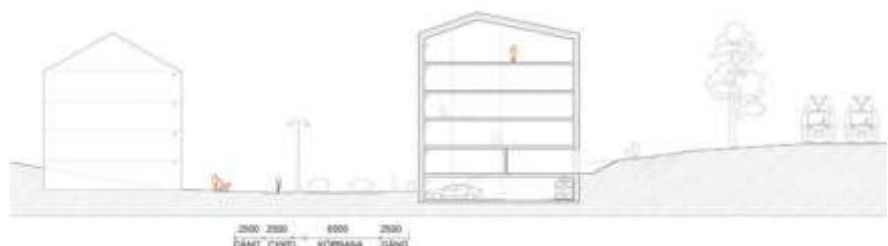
Ny sektion på Lingvägen framgår i planbeskrivningen för detaljplan för kvarteret Anisen.
